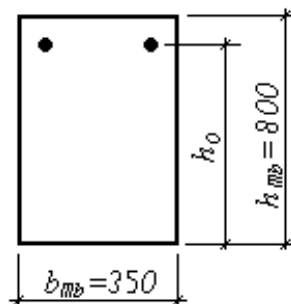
Розрахунковий переріз головної балки на опорах
